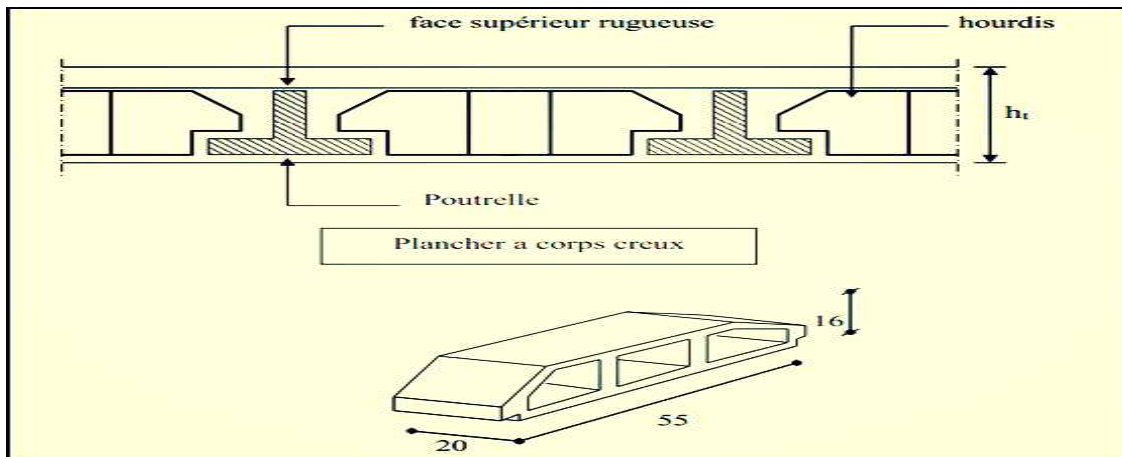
coupe transversale d'un plancher en corps creux (16+4).
